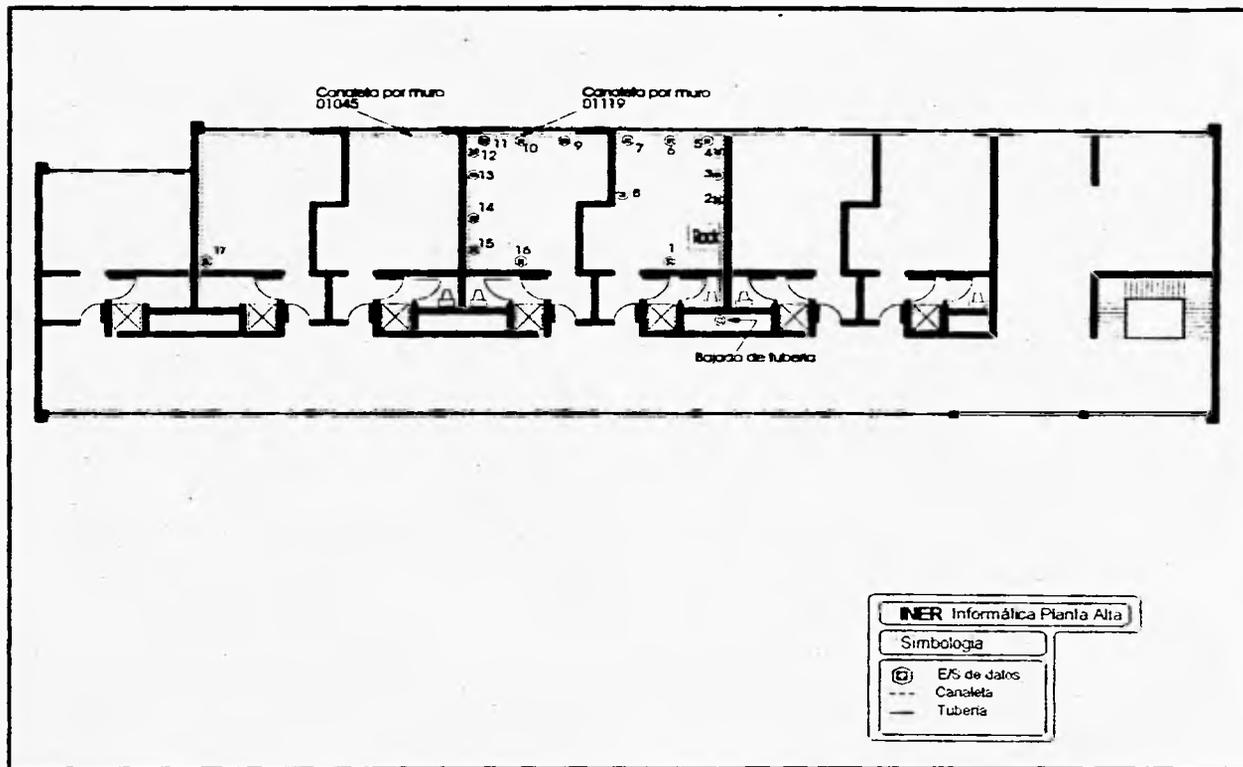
Cableado del Edificio de Informática Planta Alta
